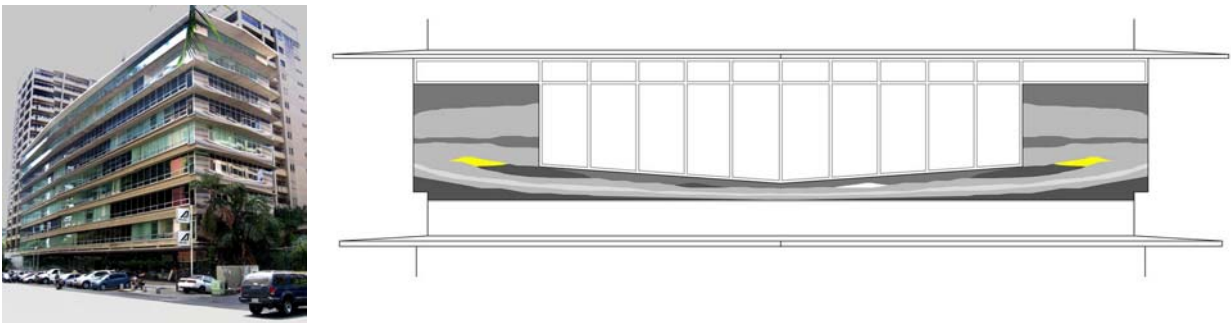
Foto Edificio Atlantic y detalle de fachada
